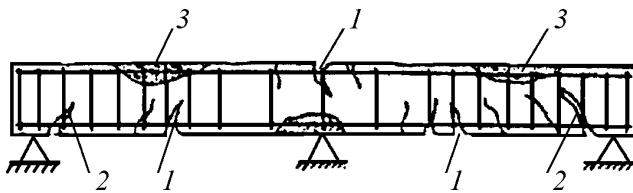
Характерные трещины в изгибающихся железобетонных элементах, работающих по балочной схеме:
